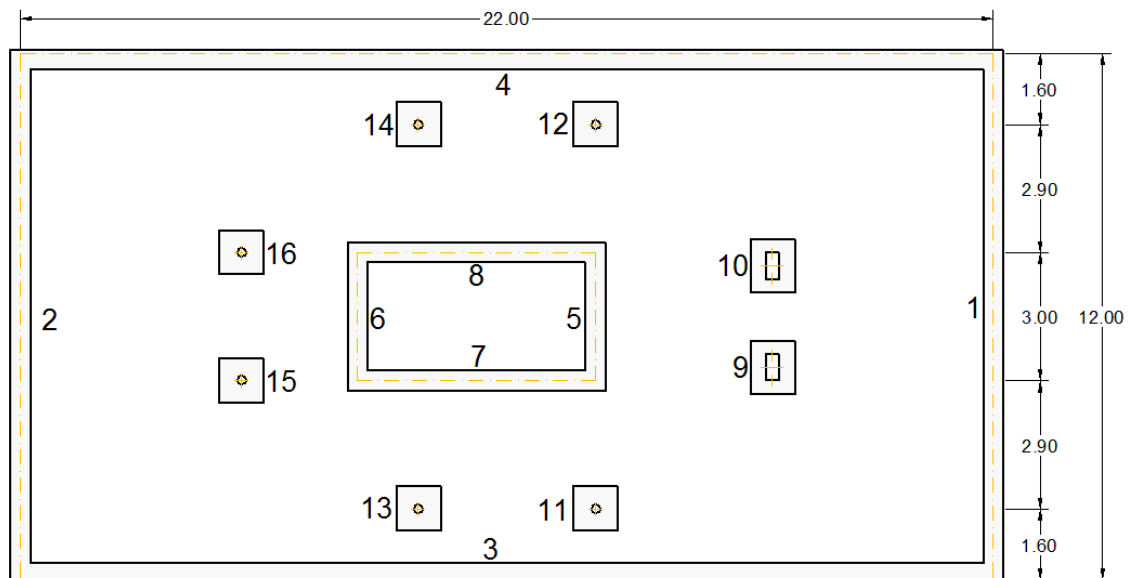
f Esquema planta cimentaciones arquetipo II
